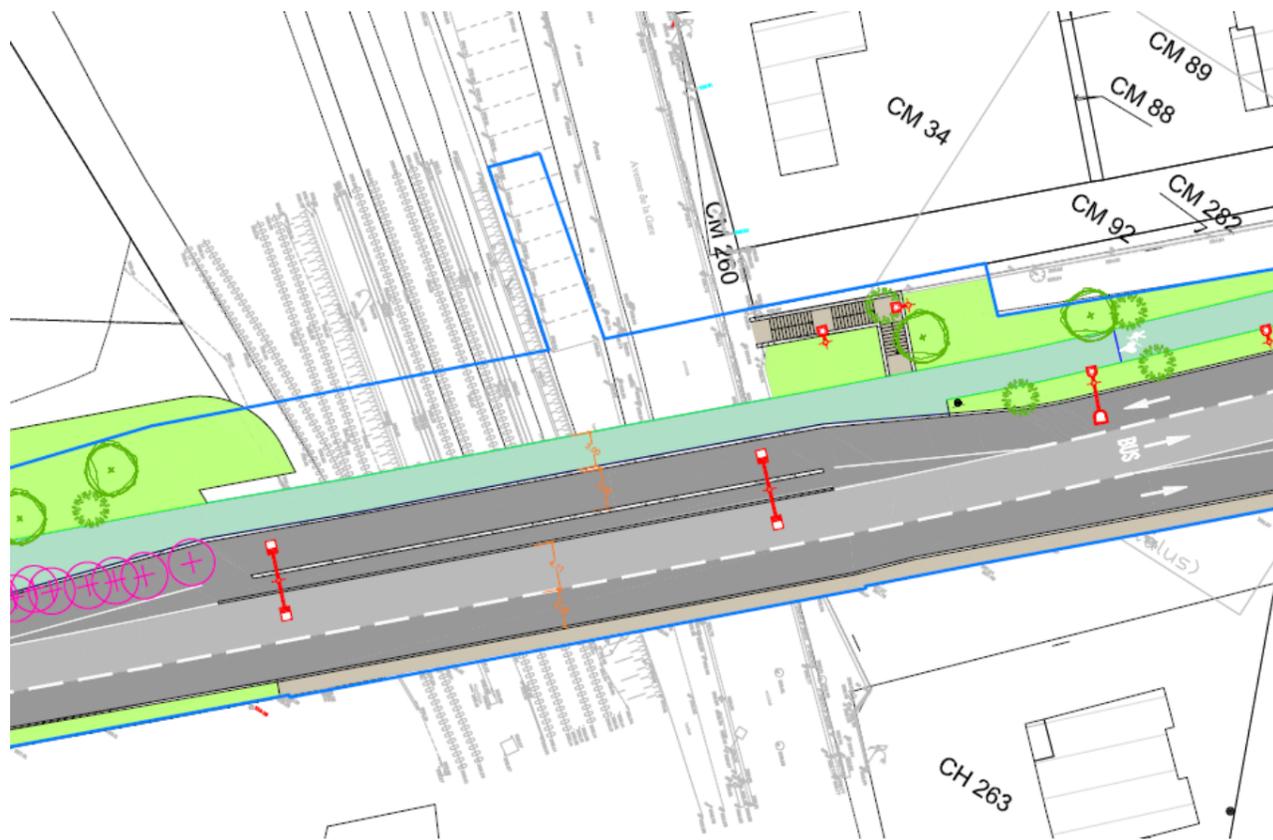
Plan d'insertion au droit de la station Leclerc (AVP)
